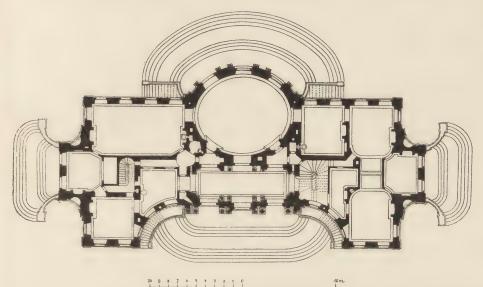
Schloss Monrepos. Grundriss.
